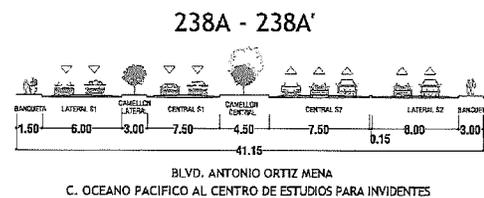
Sección vial existente Blvd. Antonio Ortiz Mena.⁶²
